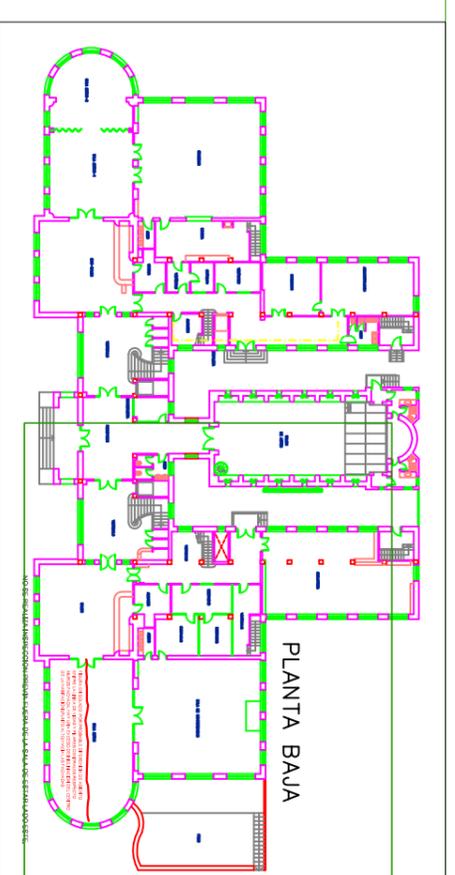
FIGURA EN SOLADO POR PROBABLE DIFERENCIA DE ASIENTO ENTRE LA LINEA DE VIGAS Y PILARES CENTRALES RESPECTO MUROS FACHADA. HAY UNA EXCESO DE INCLINACIÓN DEL CENTRO DE LA HABITACIÓN (PUNTO ALTO) HACIA LAS FACHADAS
